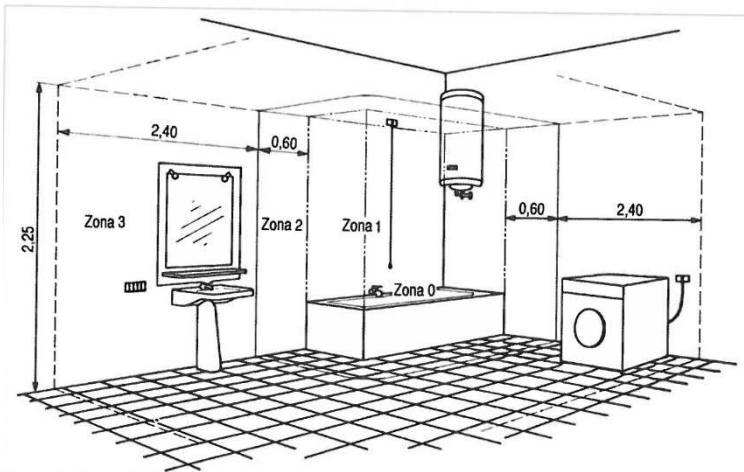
Esempio di installazione di componenti elettrici in un locale da bagno
